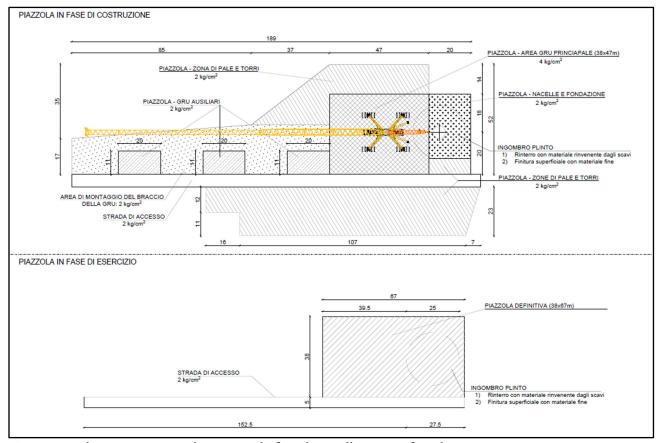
Planimetria piazzola tipo per la fase di installazione e fase di esercizio e manutenzione
